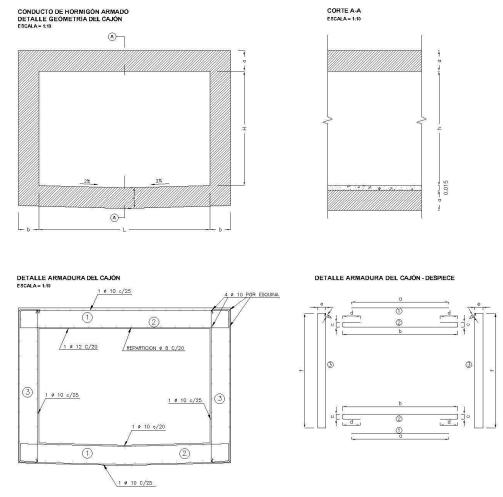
Parte de plano tipo de los conductos de hormigón armado
